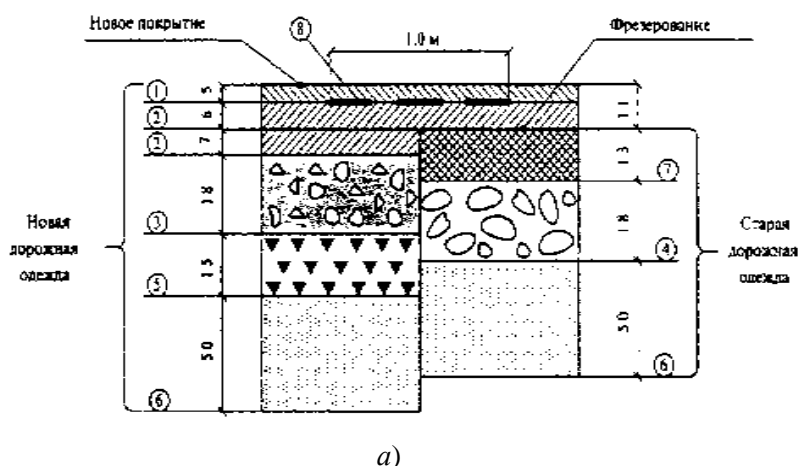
Армирование продольного шва дорожной одежды (начало):
